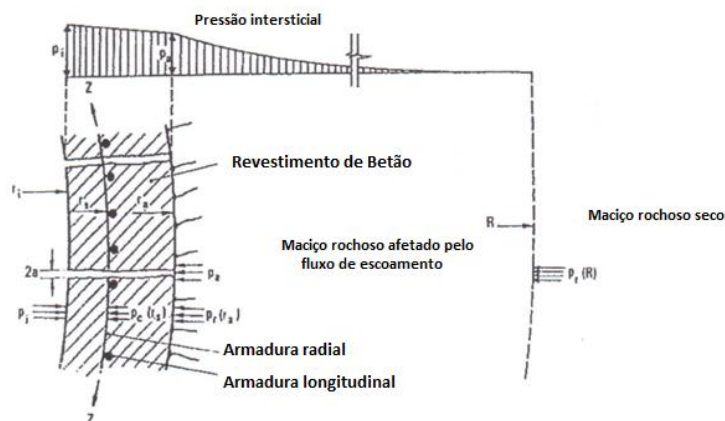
Revestimento de betão armado fissurado [7].
